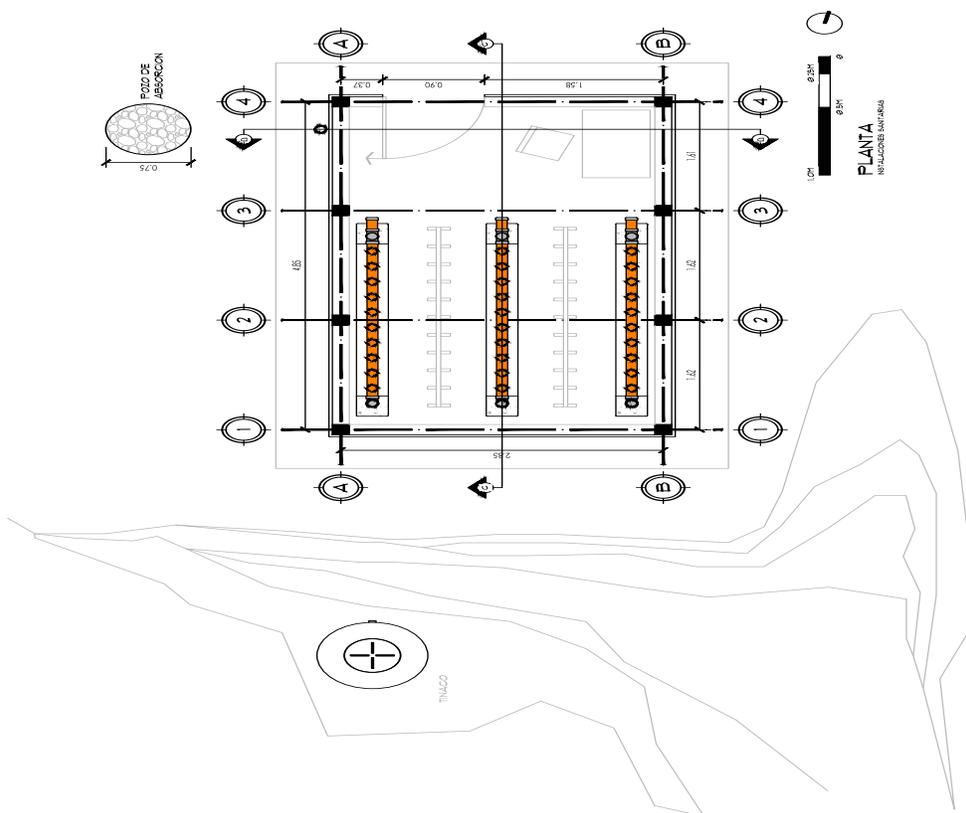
Vista de planta del prototipo de sistema de agricultura vertical.
